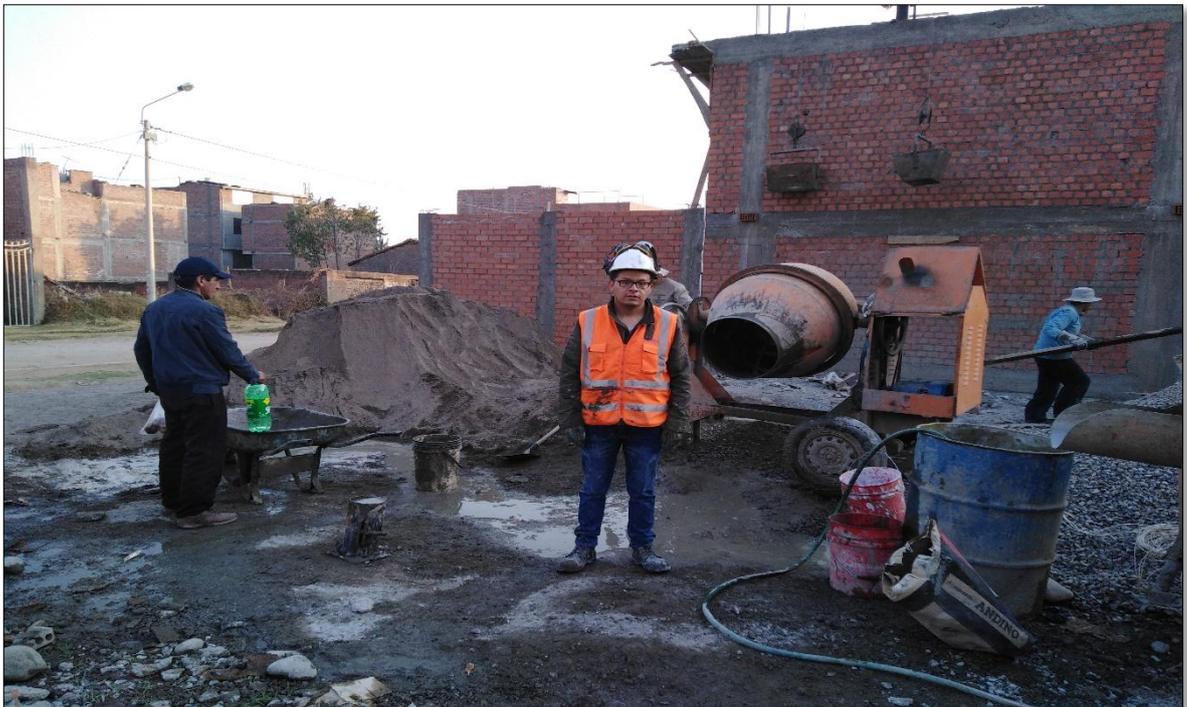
Se puede apreciar los elementos estructurales donde fueron colocados el concreto en estudio de esta investigación.
